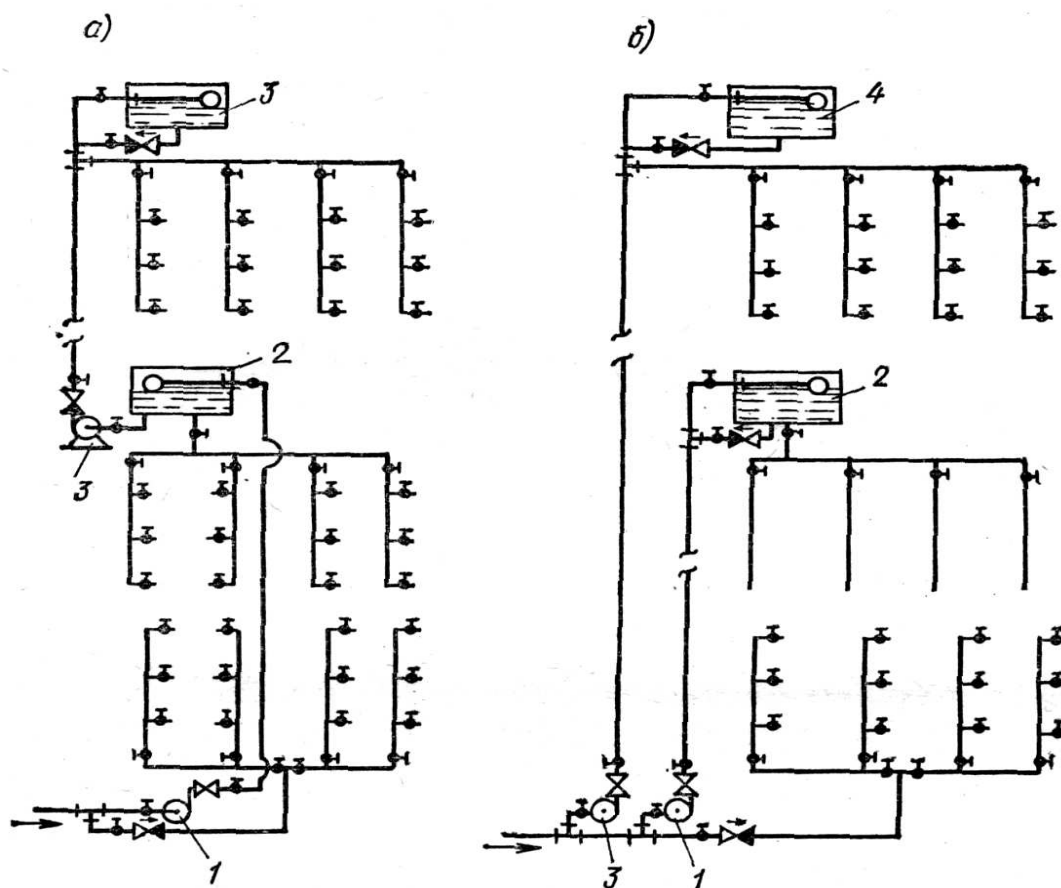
Последовательная (а) и параллельная (б) схемы зонных водопроводов зданий:
